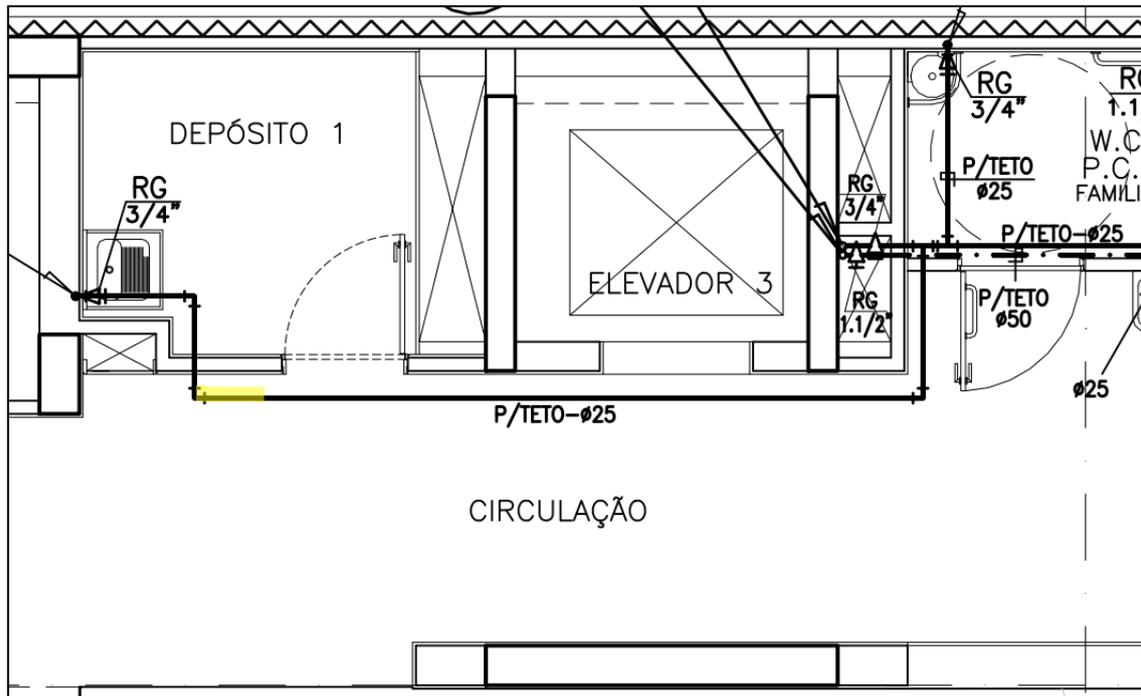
Demonstração da Patologia abraçadeira tipo gota– 2º Pavimento Circulação
